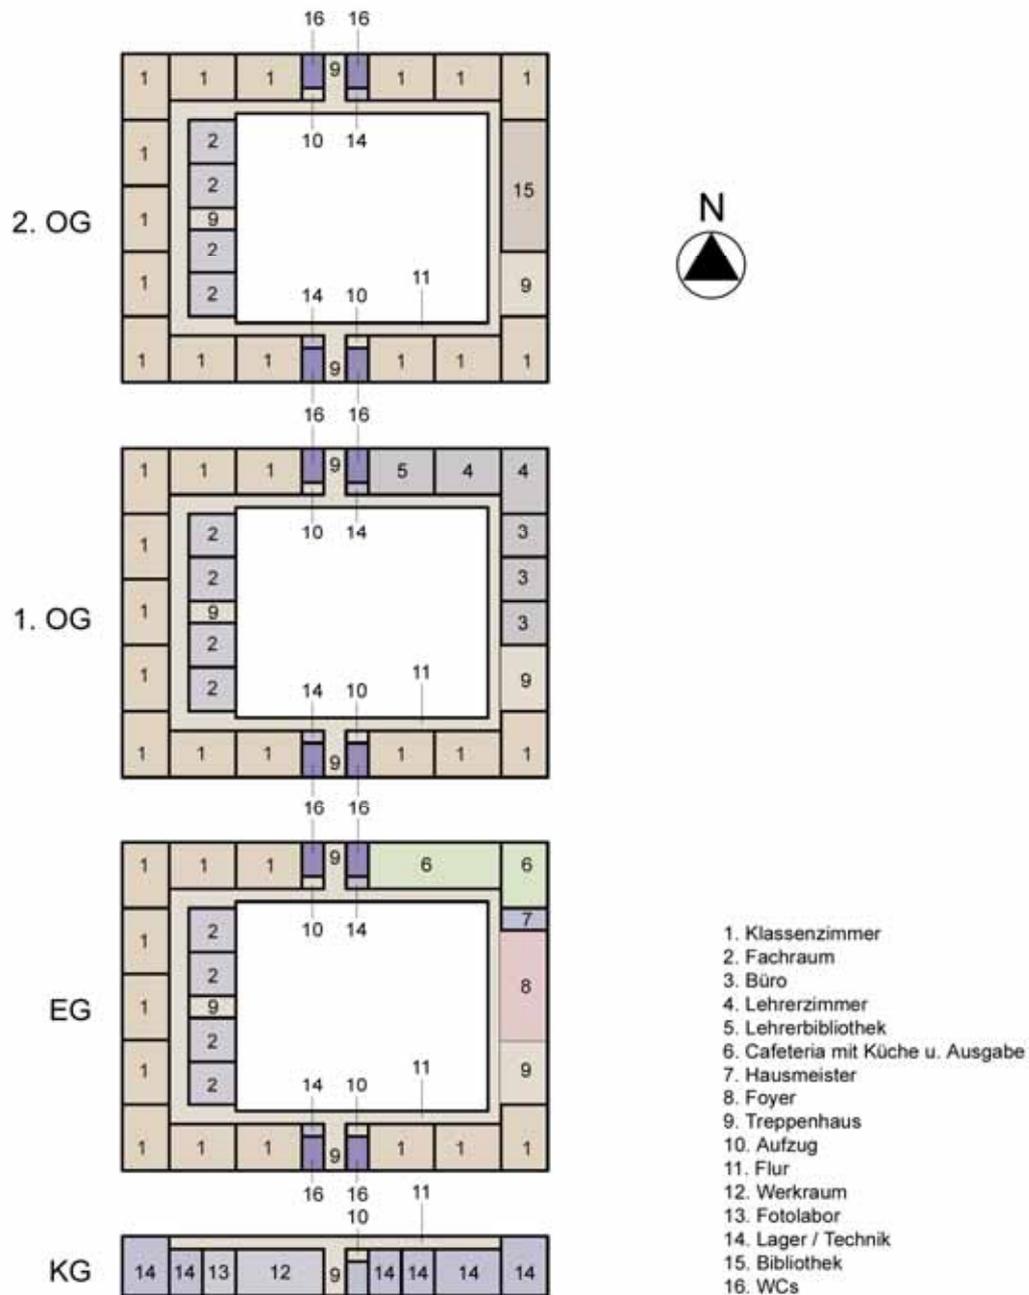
Grundrisse und Zonen des Schulgebäudes.
